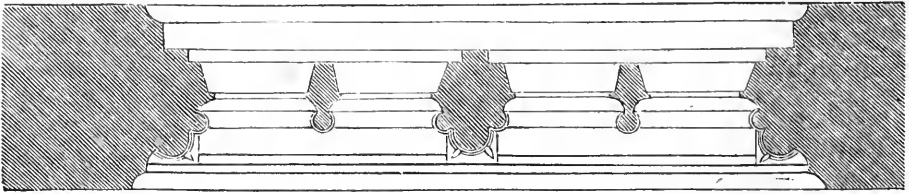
Grundriss eines Fensters zu Obermarsberg.
